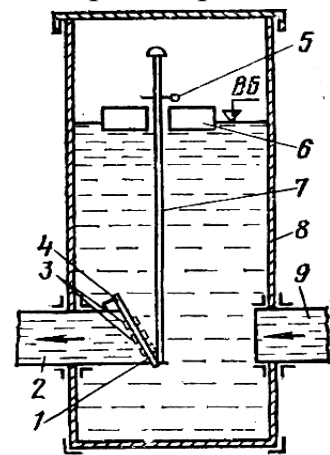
Регулятор для закрытой сети: 1 – гибкий клапан; 2 – отводящий патрубок; 3 – ребра жесткости; 4 – шарниры; 5 – фиксатор; 6 – поплавок; 7 – шток (тяги); 8 – колодец; 9 – подводный па-
